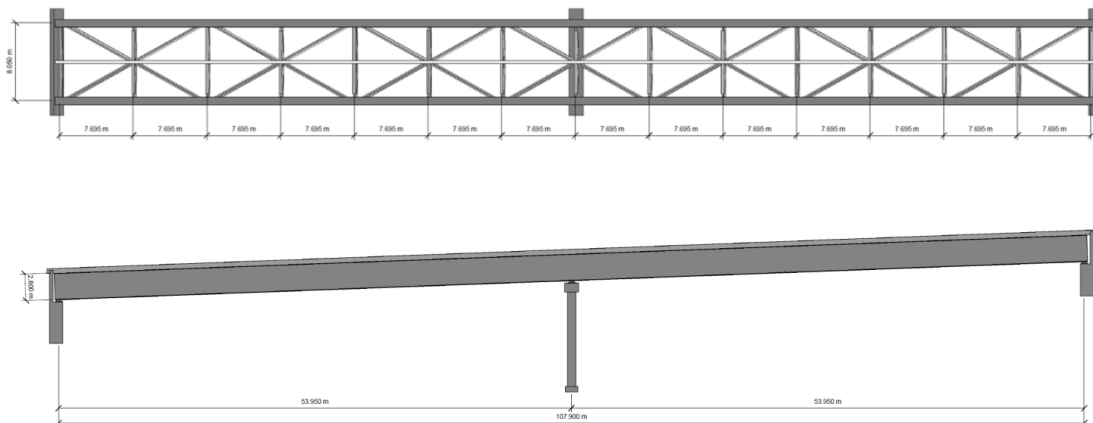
Modello BIM della seconda proposta progettuale, pianta e sezioni della struttura
